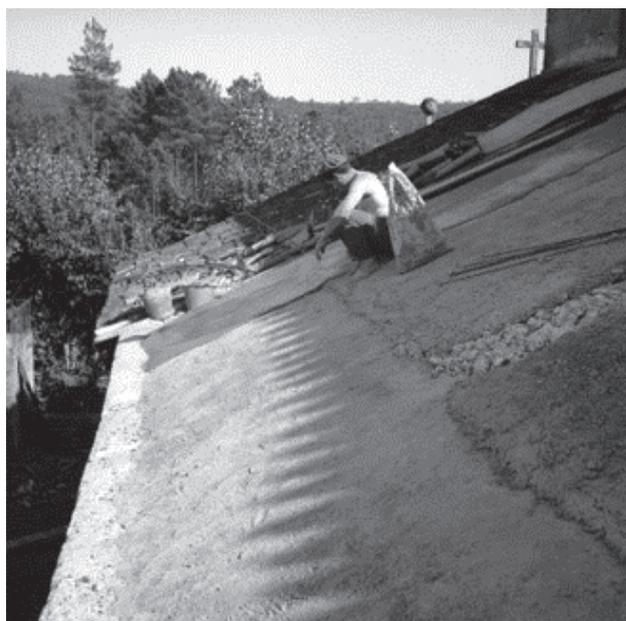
Impermeabilização, com aplicação de argamassa hidrófuga na laje de esteira da nave lateral norte. Fonte: Alberto da Silva Bessa, 1968.
